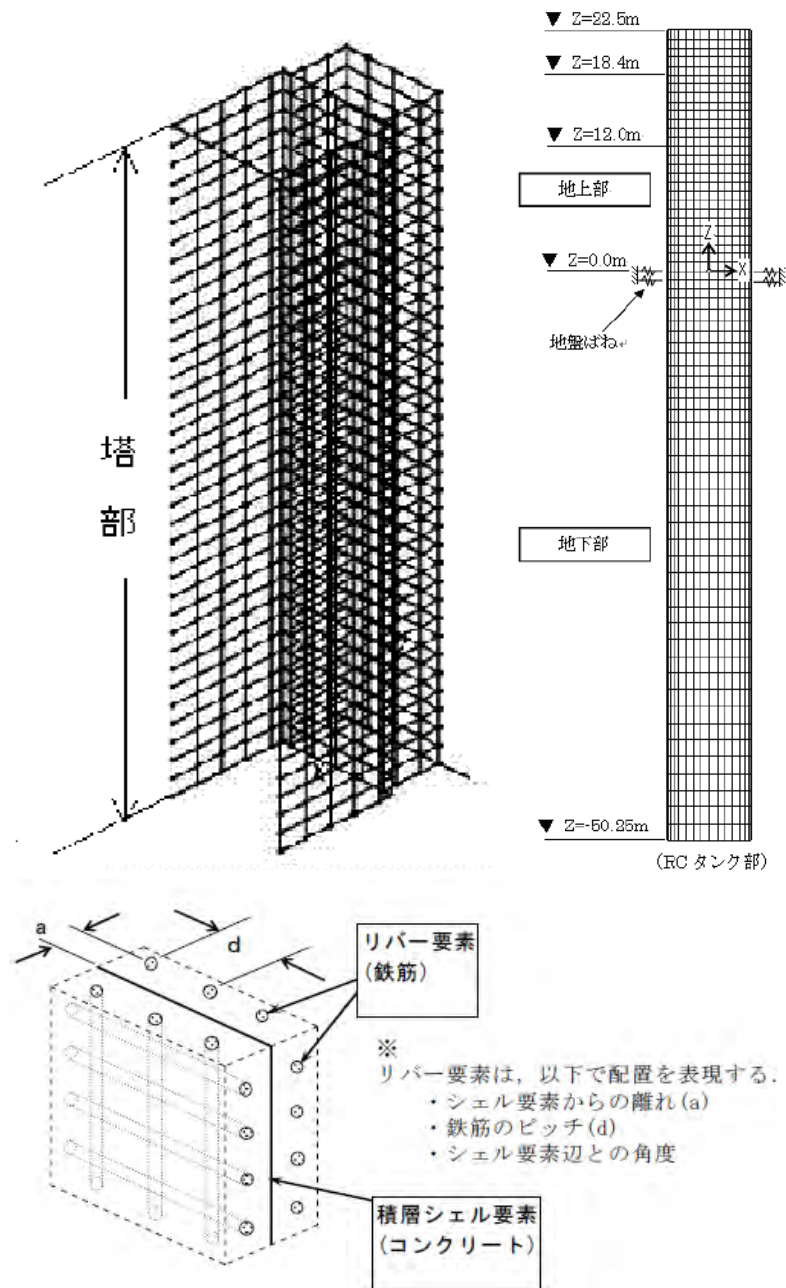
鉄筋コンクリート製取水塔のシェルモデルの例 ¹⁾P. 2-64
